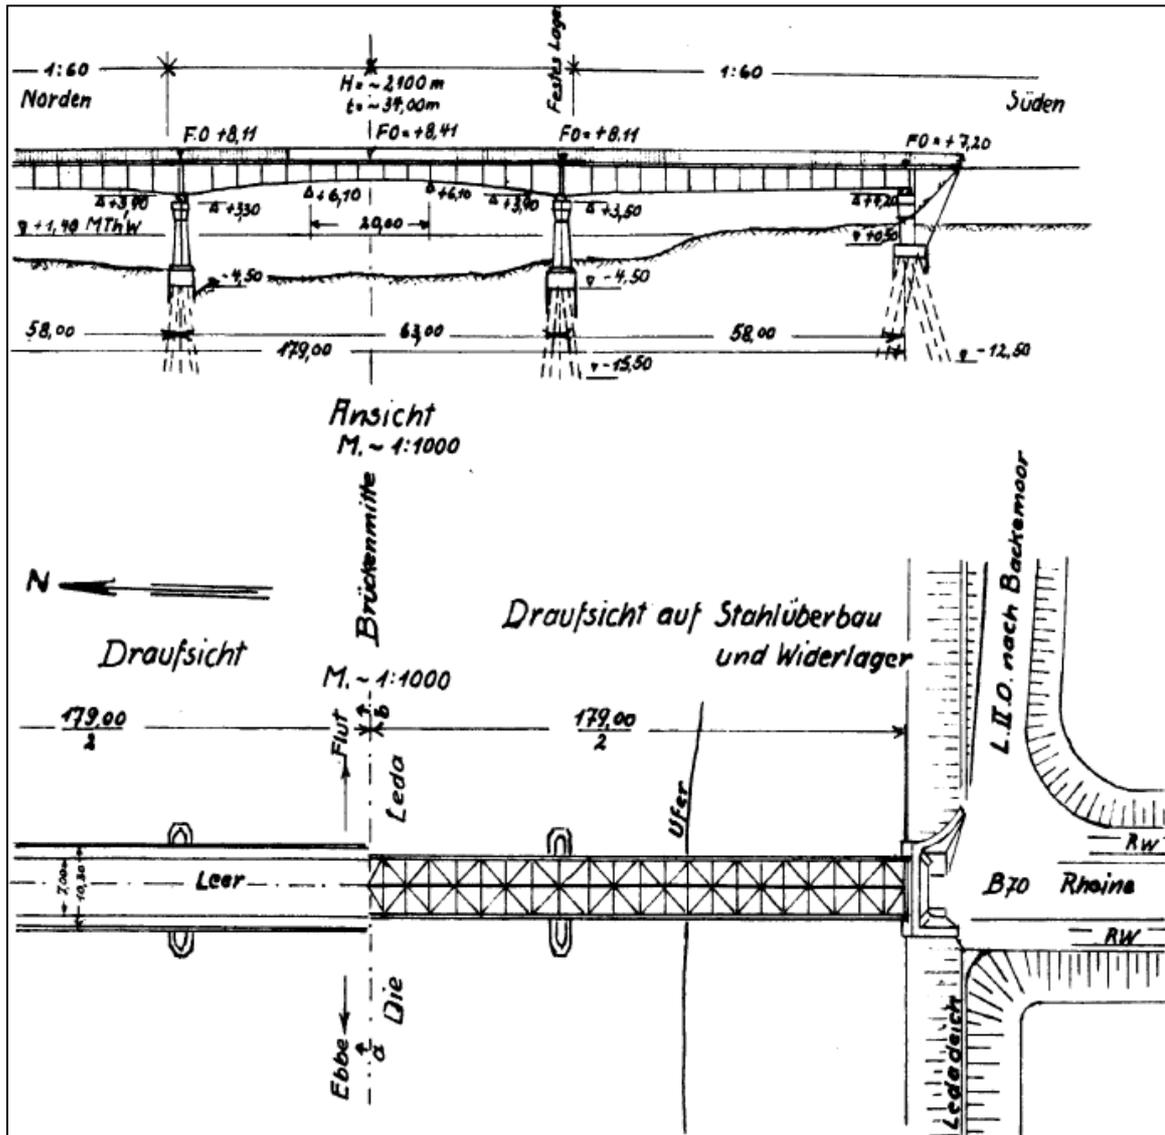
Bestandsbrücke – Ansicht und Draufsicht gemäß /1/
